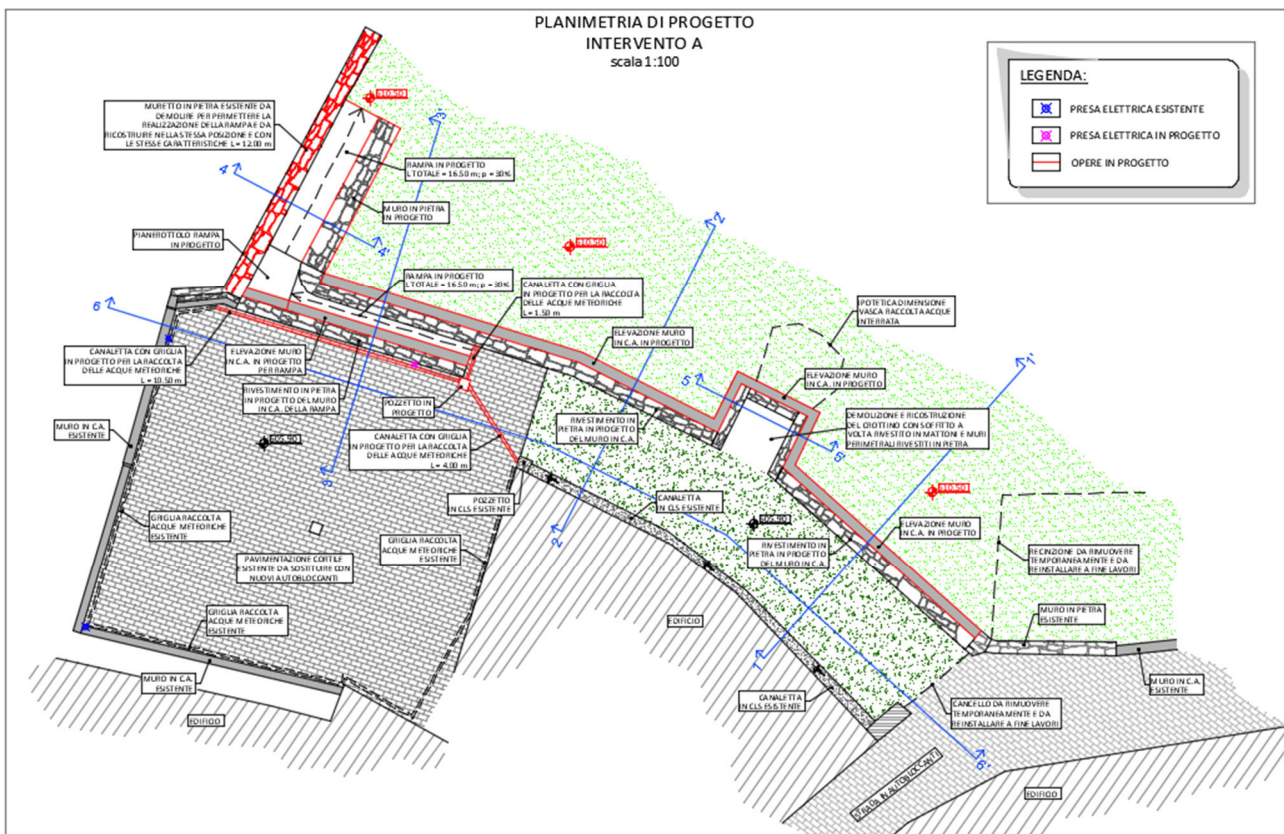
Estratto Tav.04A_Planimetria_progetto.
